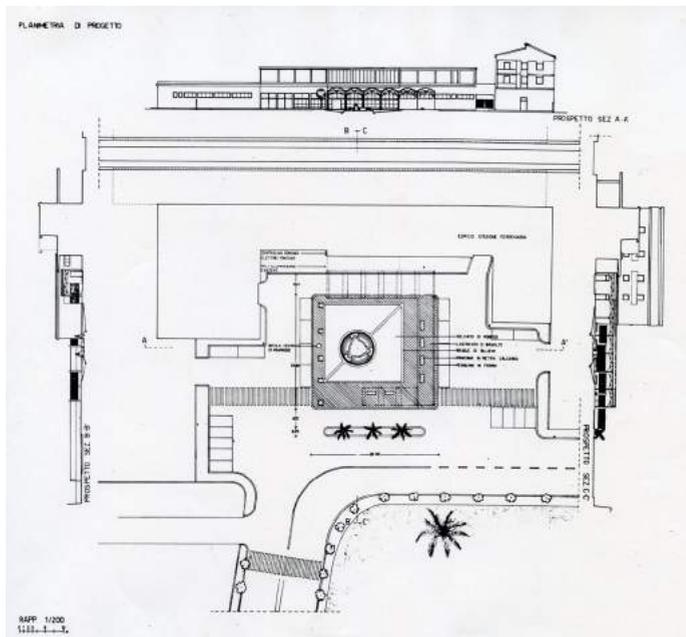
N.G. Leone, *Progetto di trasferimento della fontana Scelba nella piazza della ferrovia, (1989)*. Planimetria della nuova collocazione nella piazza della ferrovia; eseguito c.a.d., stampato in b.n. su carta, rapp. 1:200.
